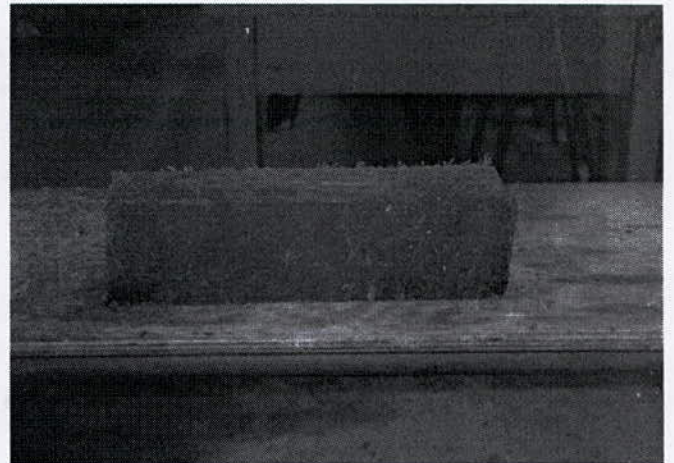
A gauche les éprouvettes prismatiques de béton blanc
